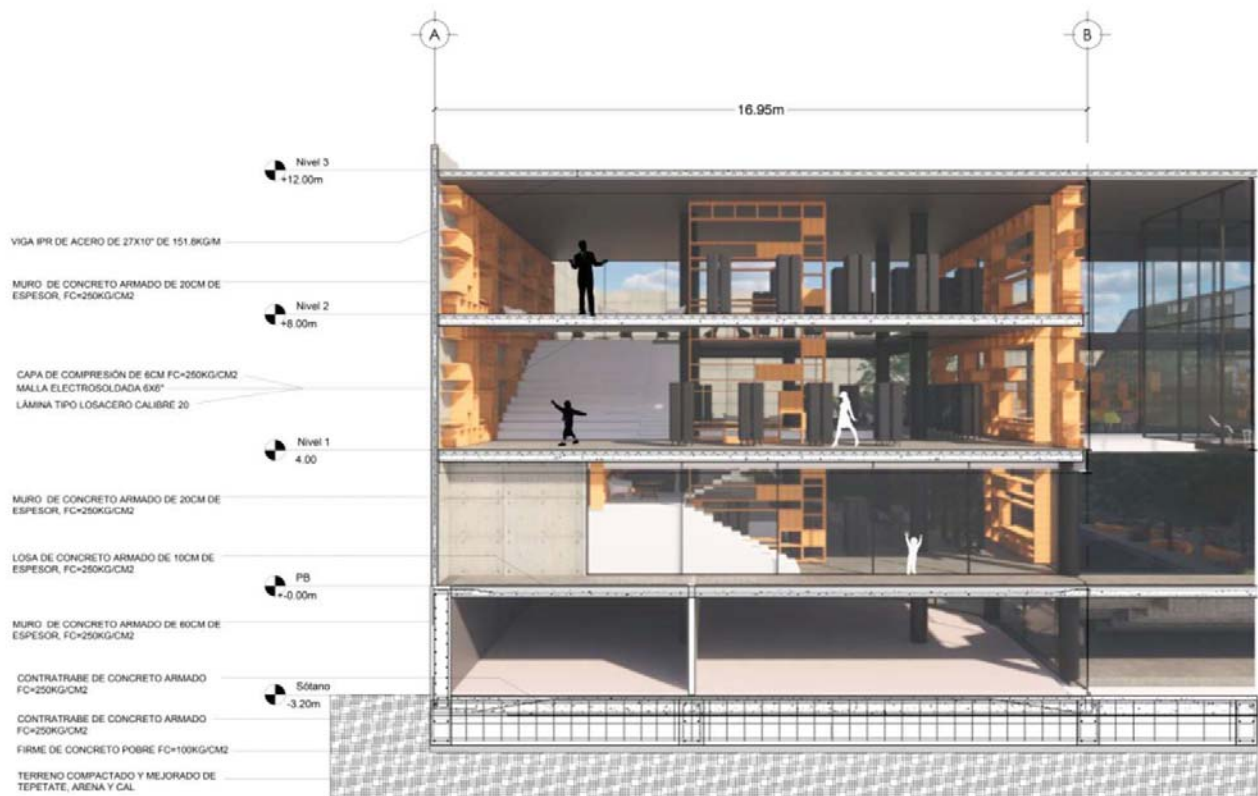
Corte por fachada cafetería, [elaboración propia].
